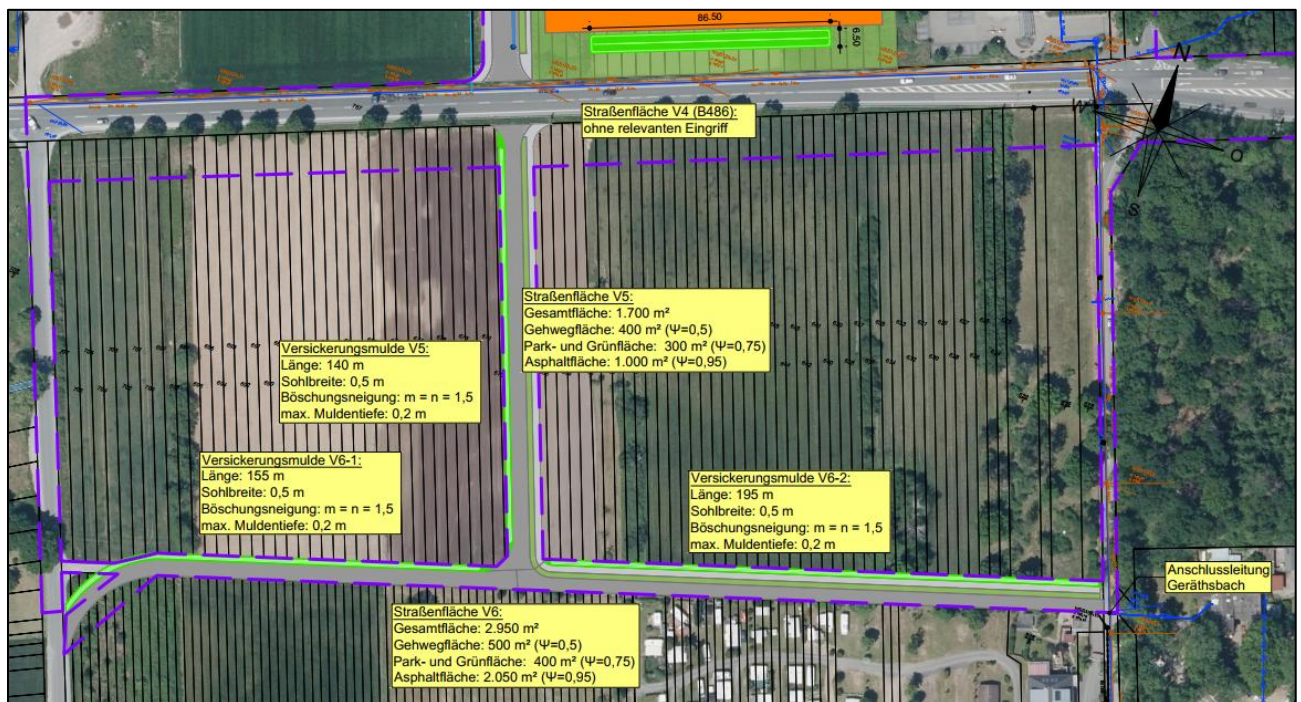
Planung Entwässerung, Verkehrsflächen V5 und V6 (Plan-Nr. W 1.3)
